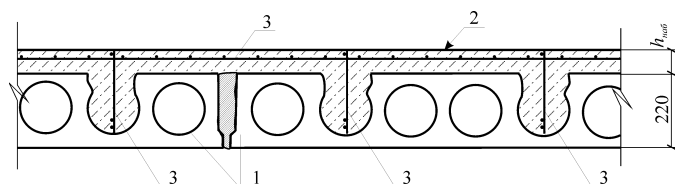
Реконструкция перекрытия, выполненного с использованием многопустотных железобетонных плит: 1 — железобетонные плиты перекрытия, 2 — усиливающий монолитный слой плиты, 3 — арматурные сетки и плоские арматурные каркасы
